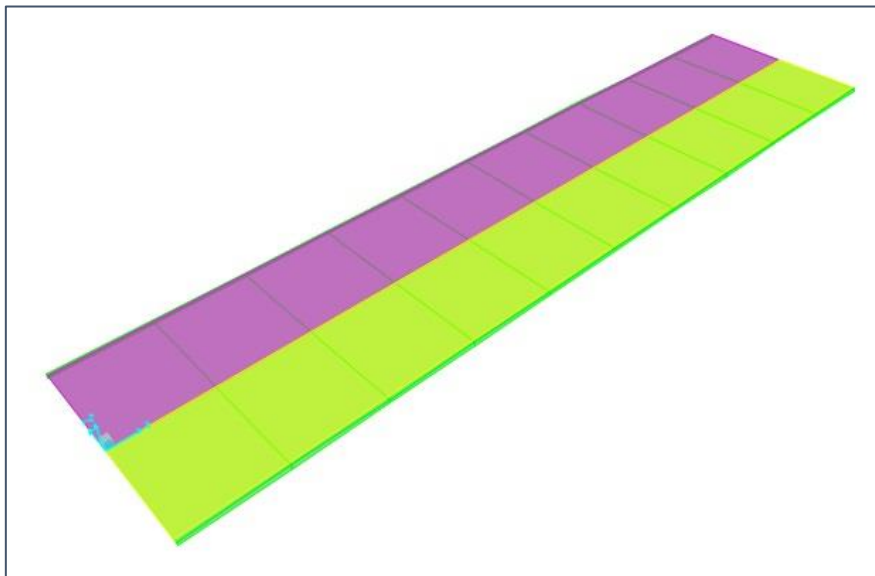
Carriles del diseño vial del puente en CSI Bridge.
